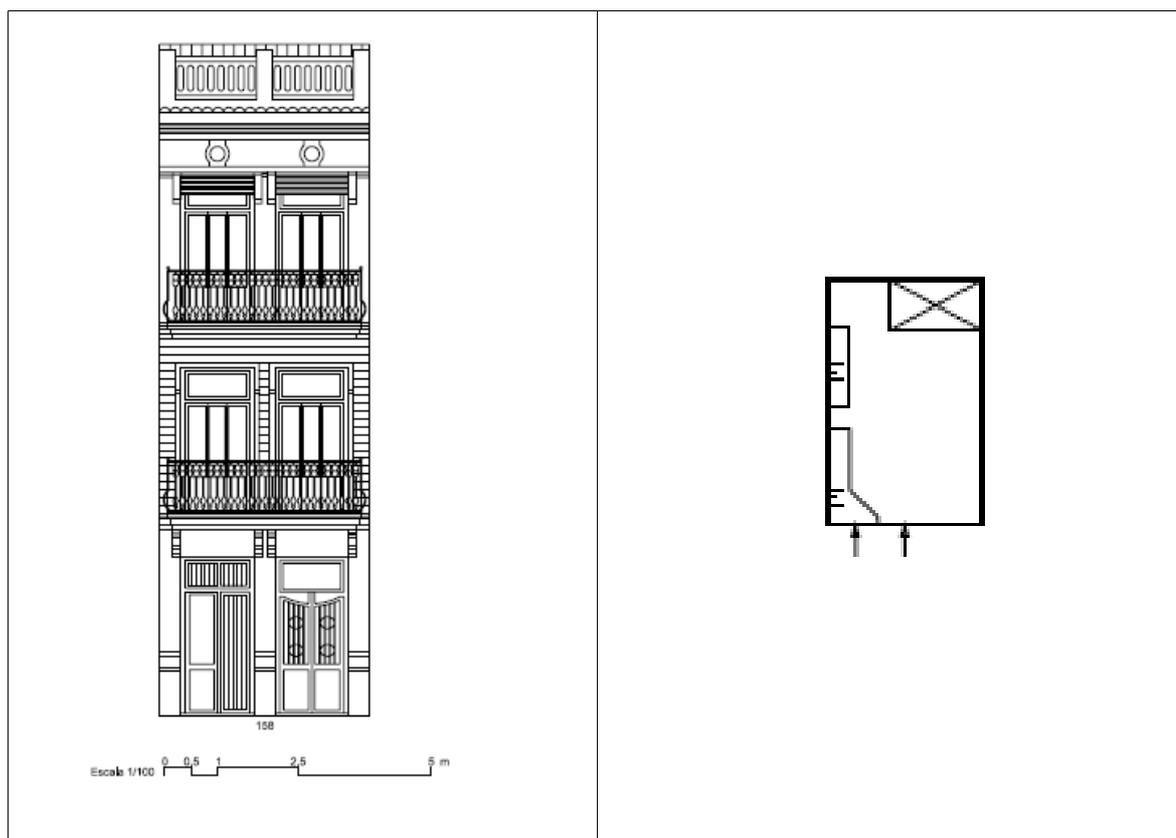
Tipo B2. Ejemplo de fachada y esquema de planta (ficha 240-02)
